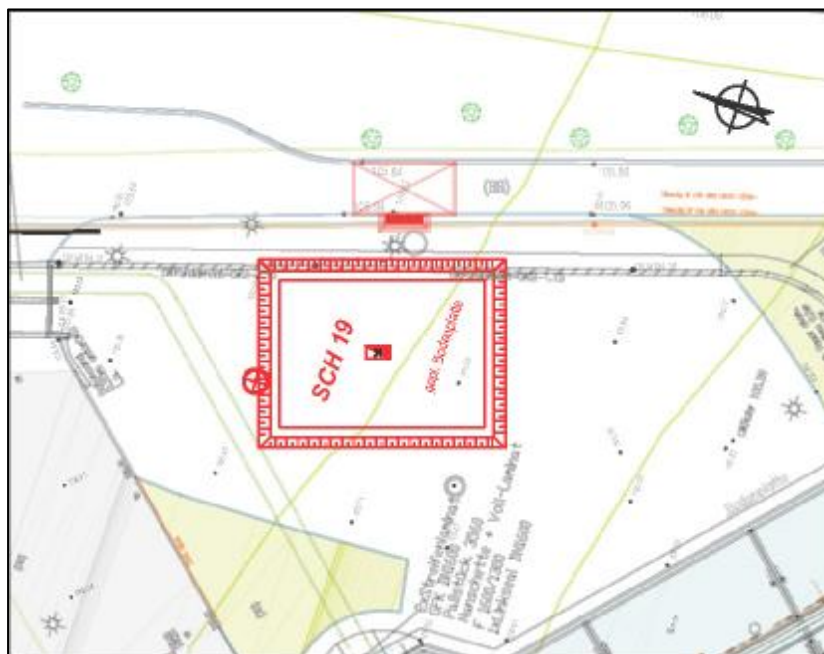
Lageplan mit Darstellung des geplanten Baggerschurfes - Dosierstation
